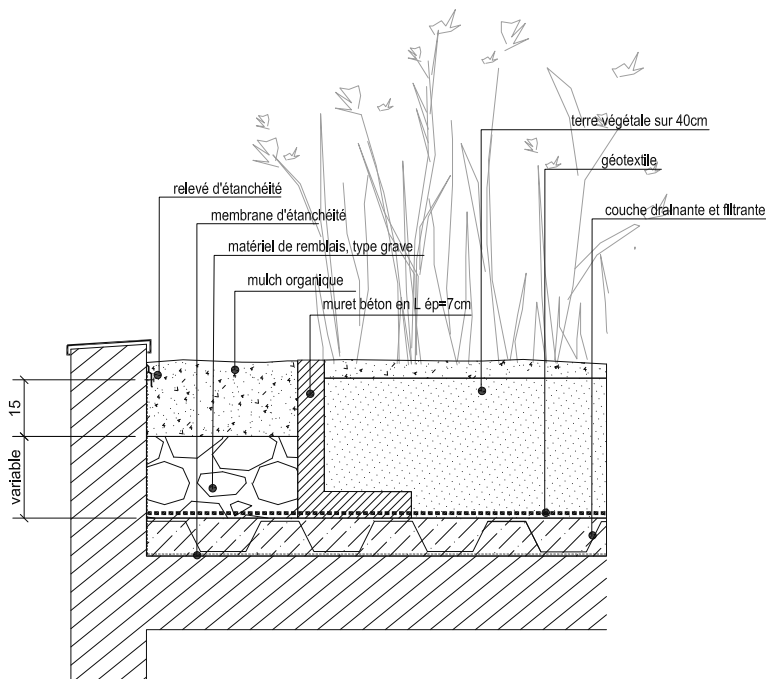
Détail technique d'une bande stérile (Source : Le Saout, 2016)
